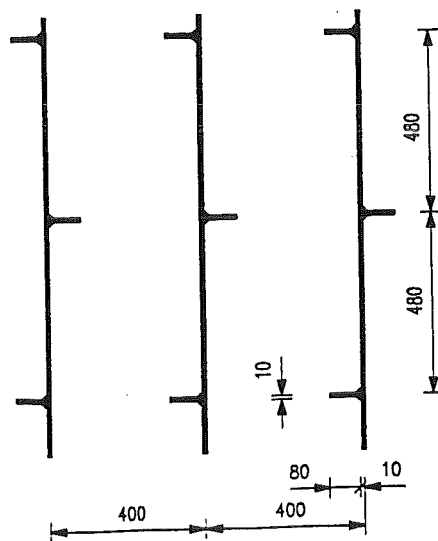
Längsschnitt durch die Stützrippen des Liners
